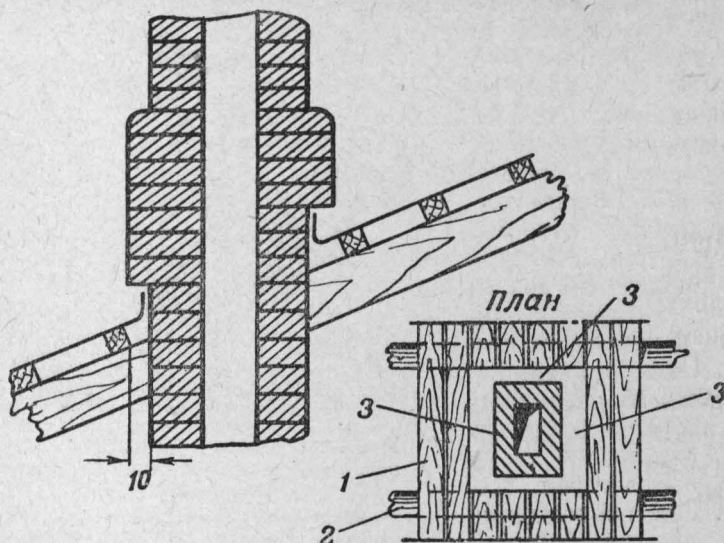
Отступка дымовой трубы от деревянных частей кровли:
